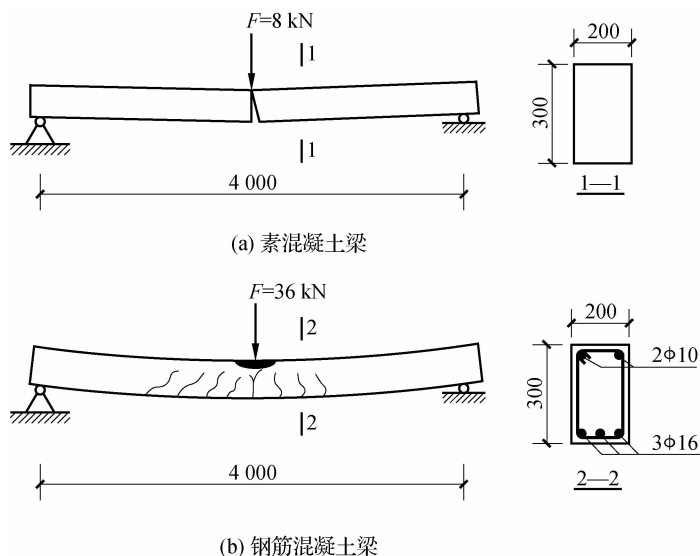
素混凝土梁与钢筋混凝土梁的破坏情况
